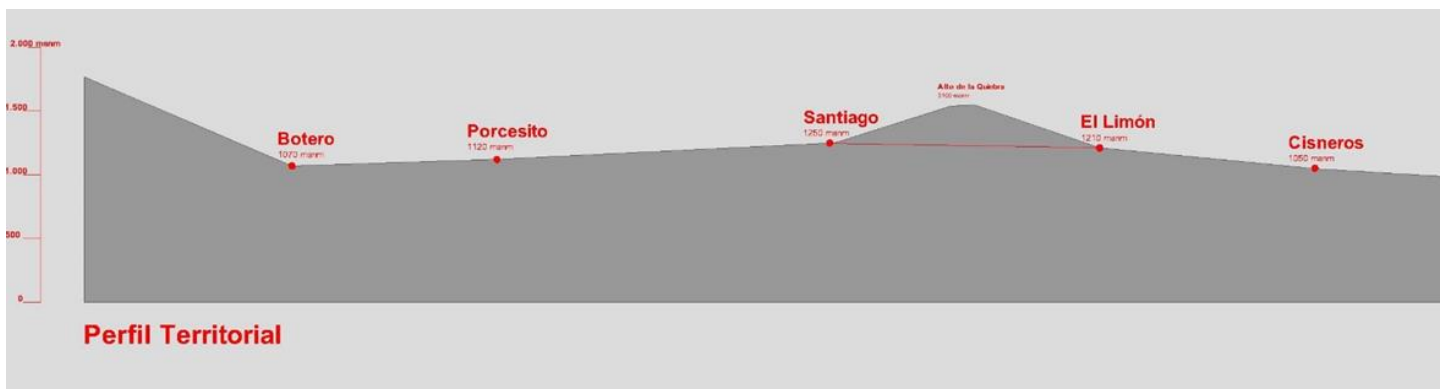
Sección longitudinal del trayecto piloto. Fuente: Elaboración propia
